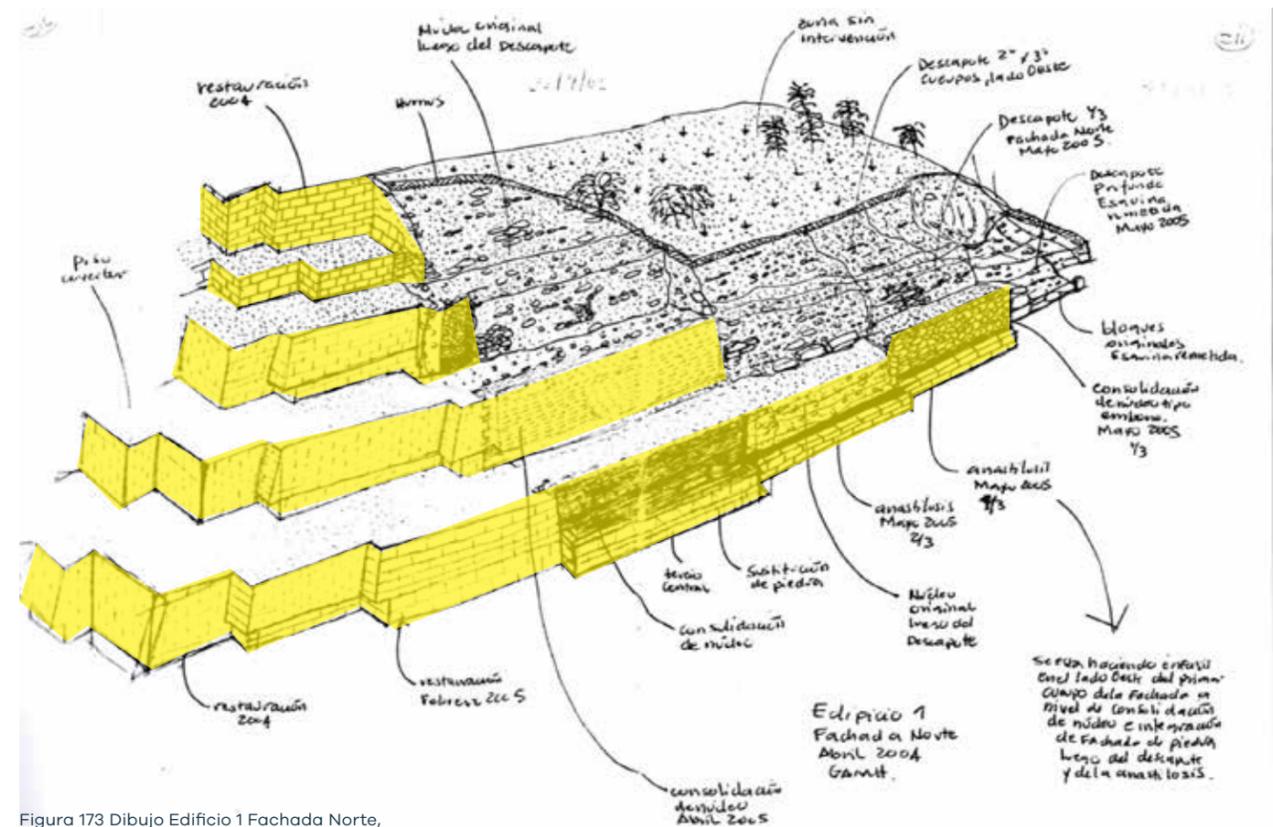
Dibujo Edificio 1 Fachada Norte, consolidación e integración de fachada de piedra luego del descapote y anastilosis. Dibujo: GAMH 2002
